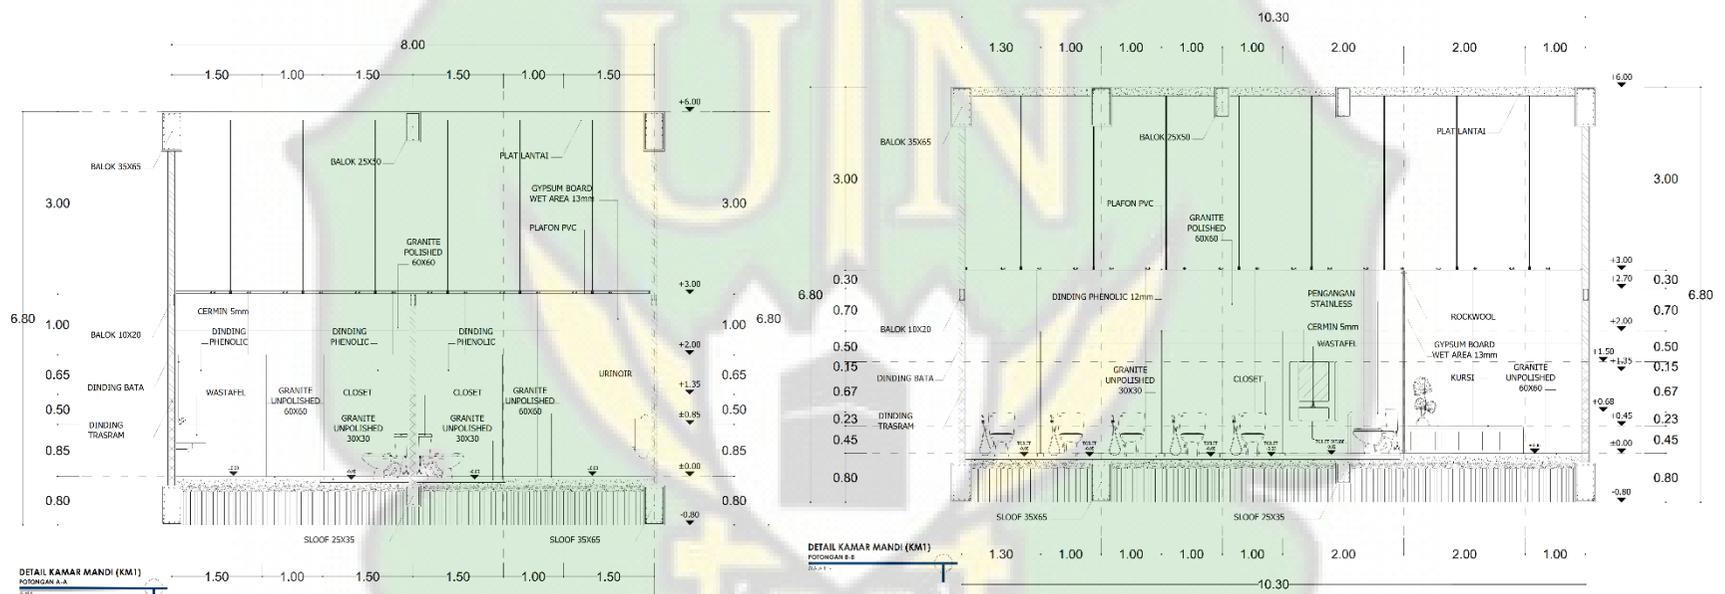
Denah Rencana Kamar Mandi Lantai Dasar
